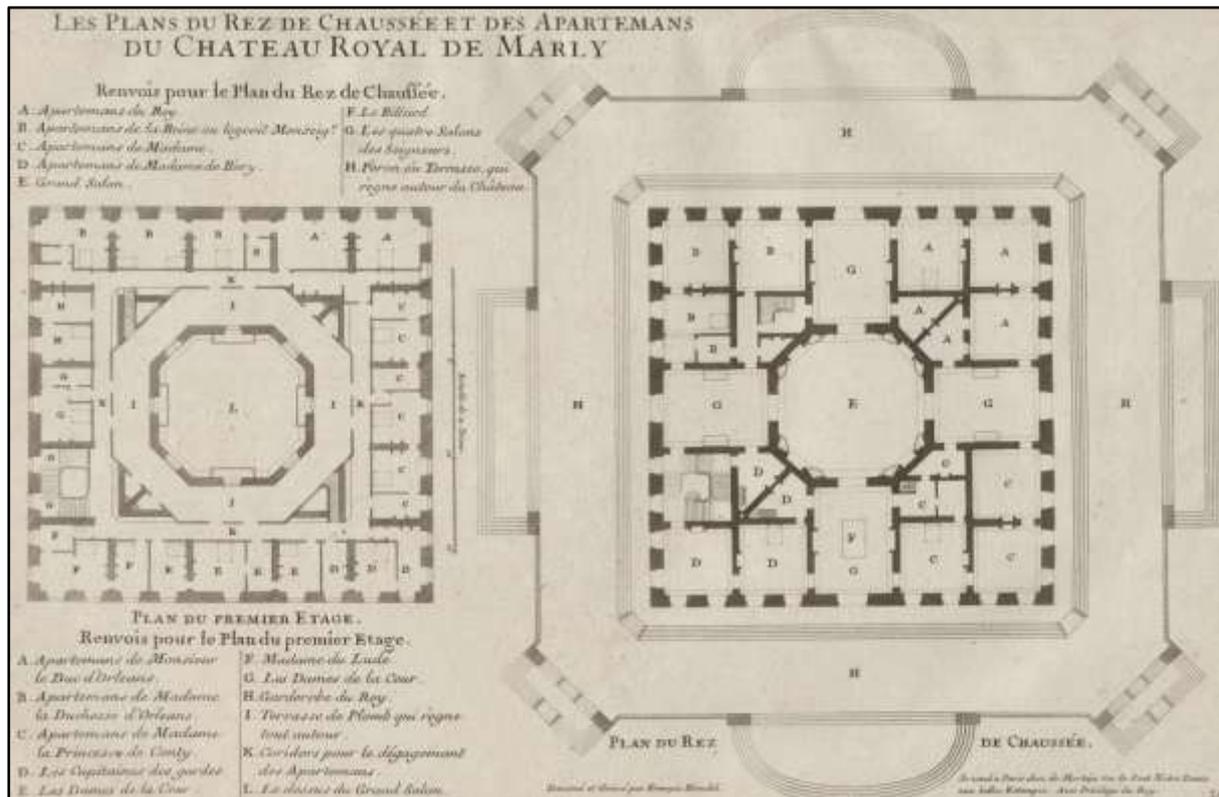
« Les Plan du Rez de Chaussée et des appartemens du Château Royal de Marly, Dessiné et Gravé par François Blondel ». dans *Les Plans, Profils, Et Elevations, Des Ville, Et Château De Versailles : avec les Bosquets, et Fontaines, tels quils sont a present, levez sur les Lieux, Dessinez et Gravez en 1714 et 1715.* Paris, 1715. pl. 36.
